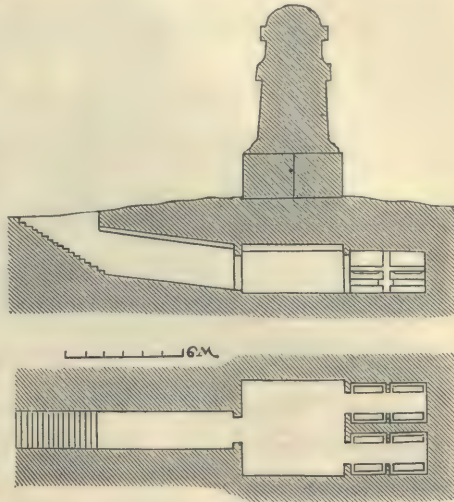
a u. b. Grabkammer mit Gang. Grundriss u. Durchschnitt. Phönicien.
